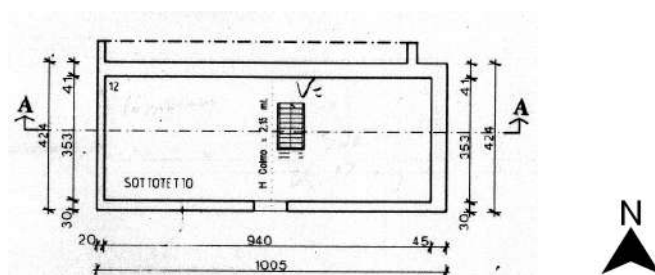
Planimetria abitazione piano sottotetto - stato reale
